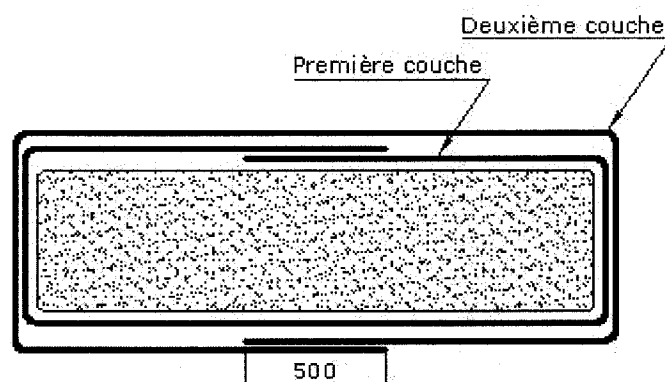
Schéma du renforcement appliqué au pilier 3
